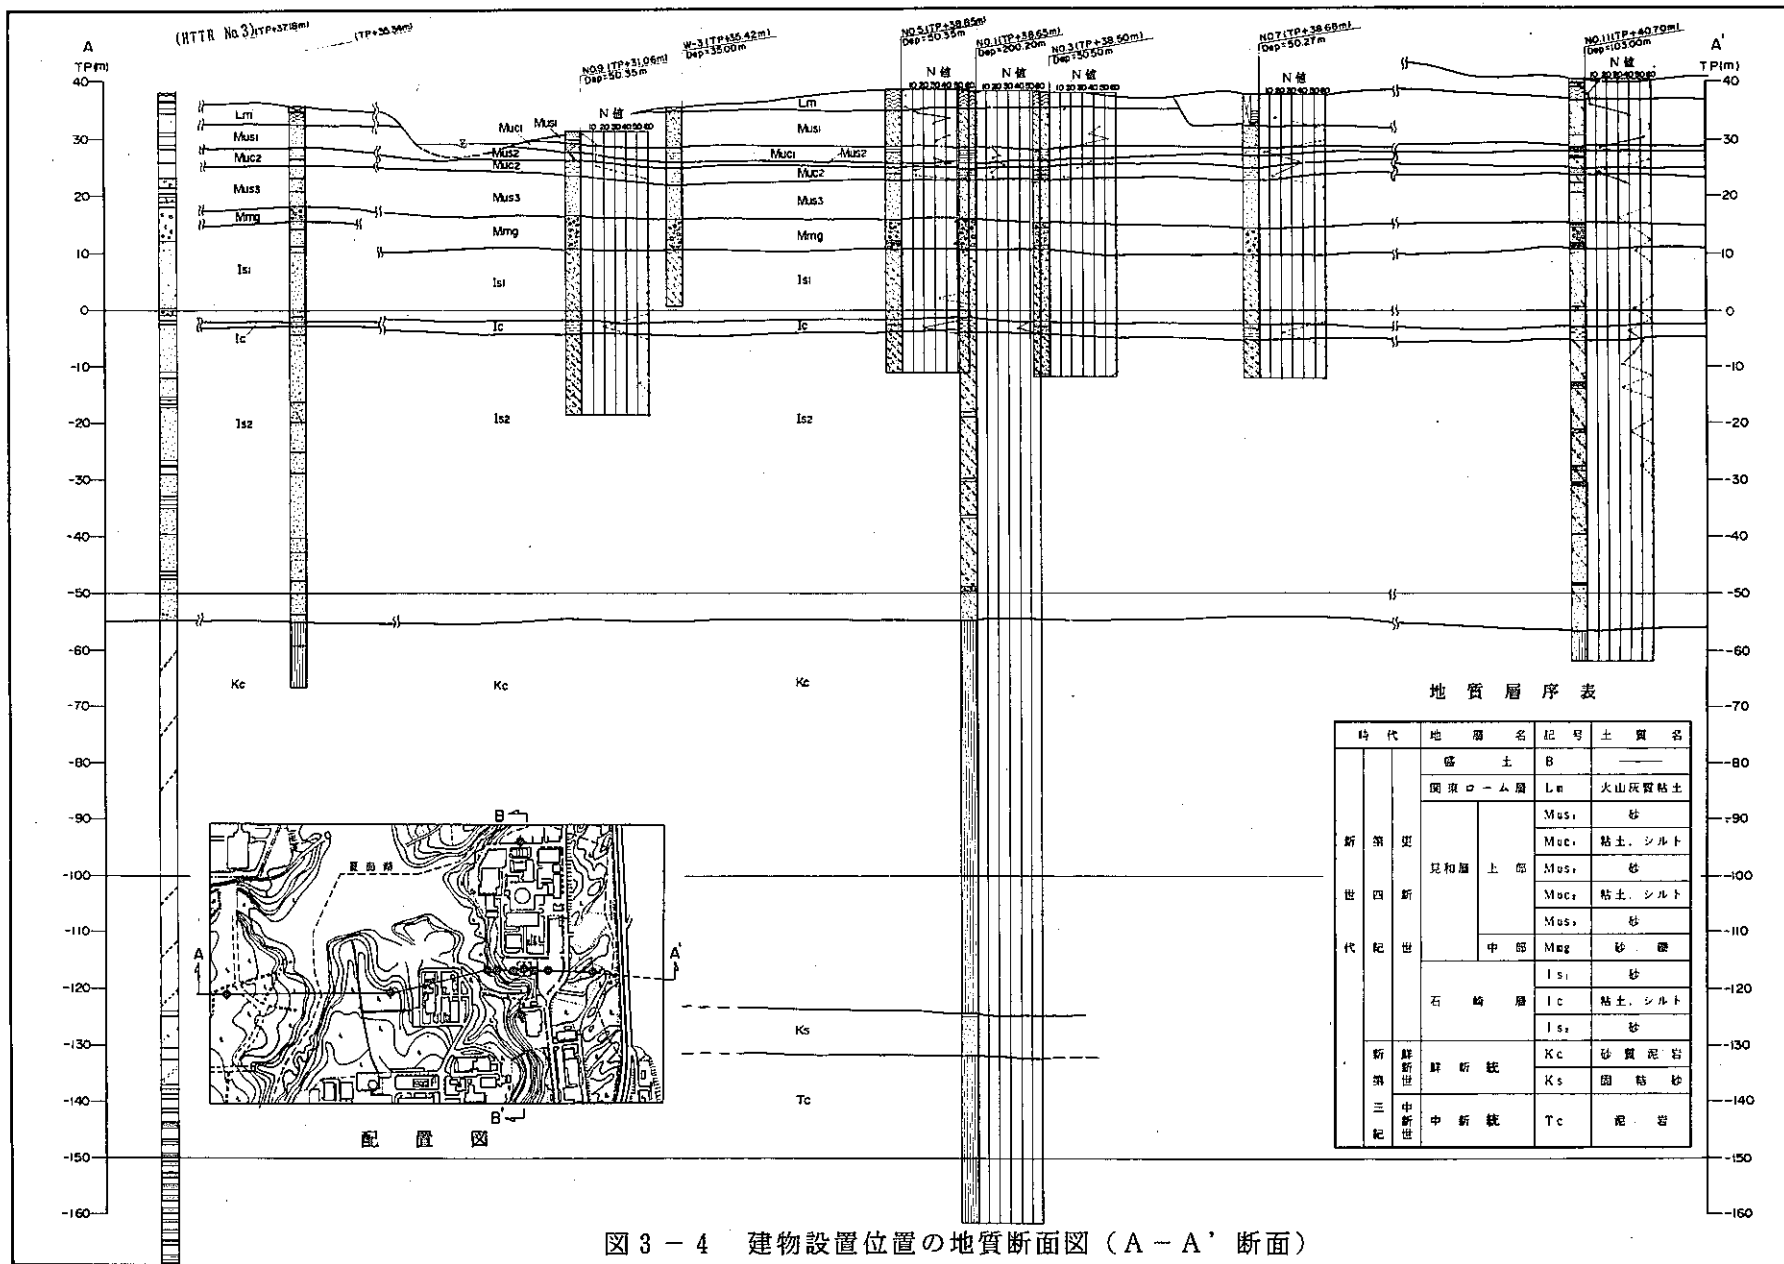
4 建物設置位置の地質断面図 (A - A' 断面)
